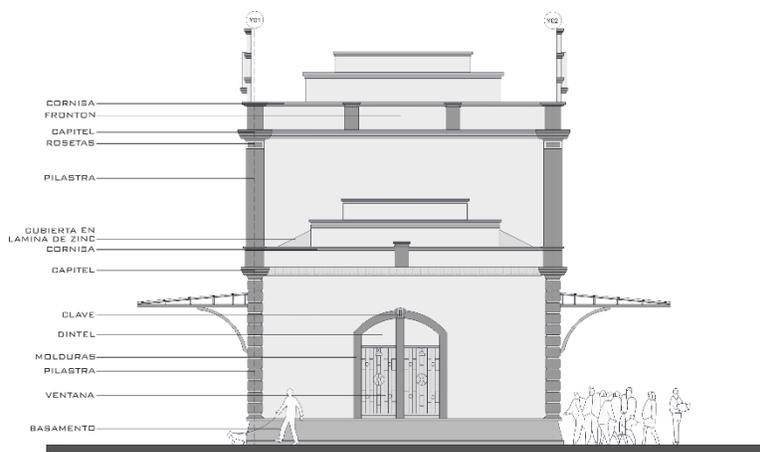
Alzado lateral derecho, Estación del ferrocarril Sur.
